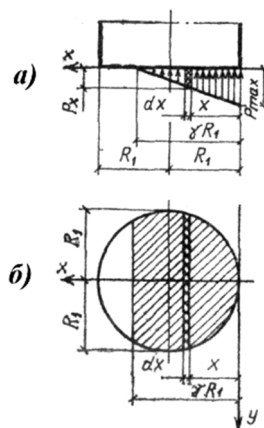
Схема для определения объема эпюры давления круглого фундамента на грунтовое основание и его условного статического момента относительно оси y : а) продольный вид; б) вид в плане
